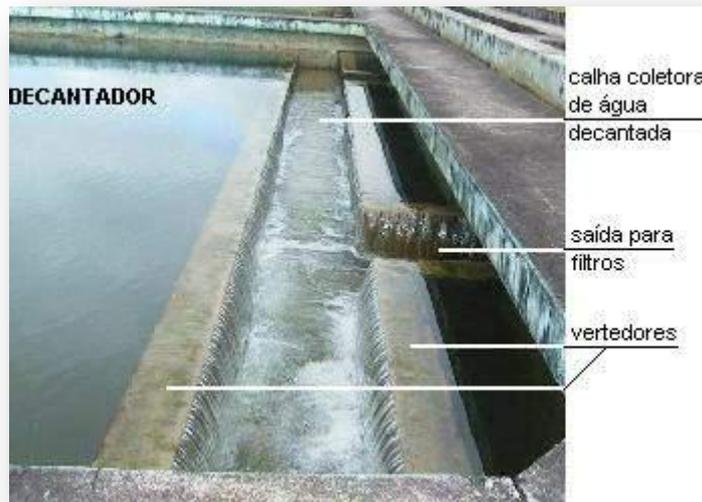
Um detalhe da calha coletora de água decantada
